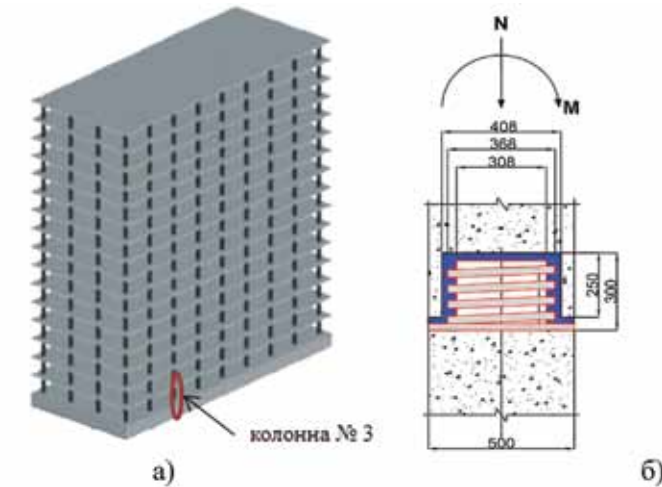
а) Многоэтажное здание; б) Разрез колонны № 3
